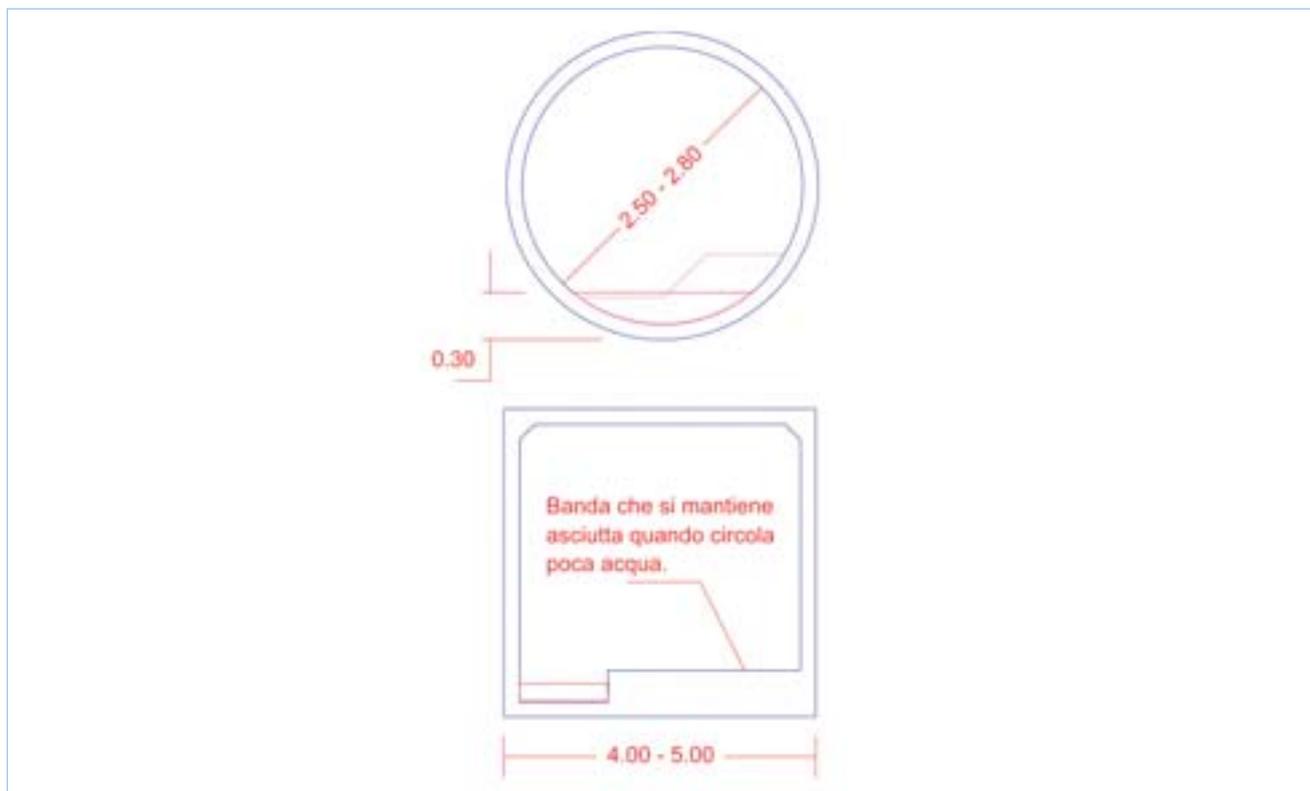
Adattamento di tombini di drenaggio e scatolari idraulici per il passaggio della fauna (tratto da Rivella – UTET Scienze Tecniche)
